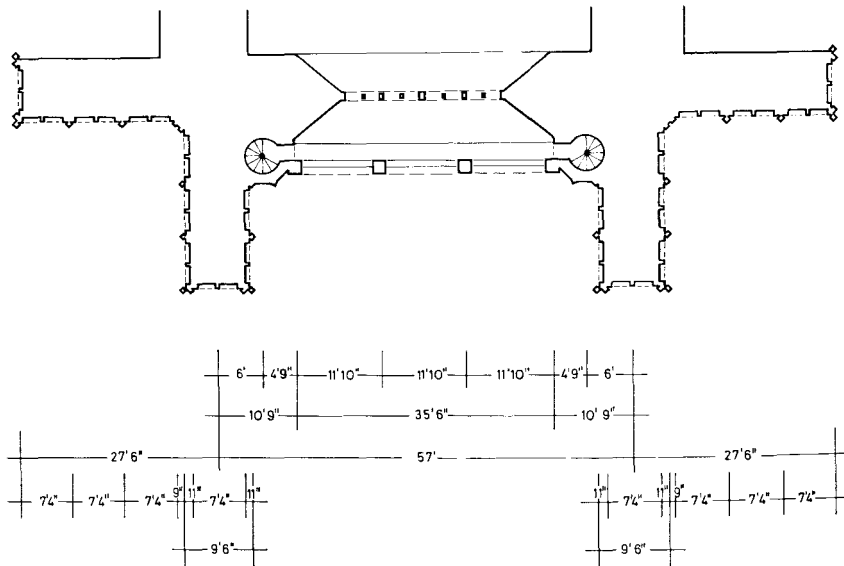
Ulm Münsterurm Riß D, schematischer Grundriß des Martinsgeschosses.
